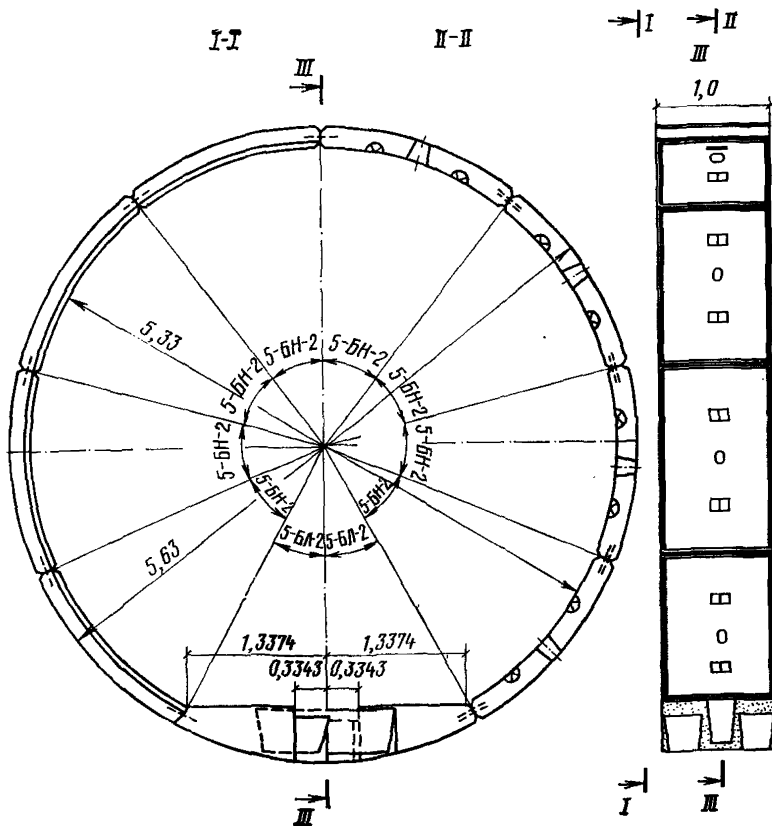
Конструкции сборных железобетонных блоков 5-БНЛ-2
